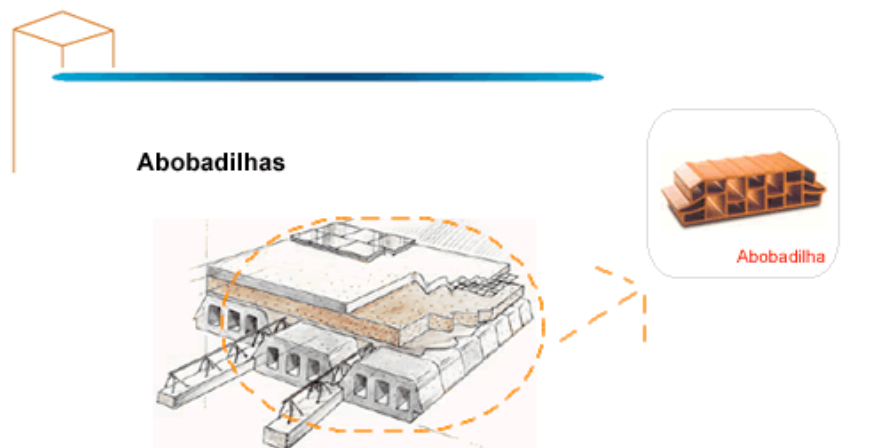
, Abobadilha da fabrica Preceram, (imagem com cortesia de fabrica)
